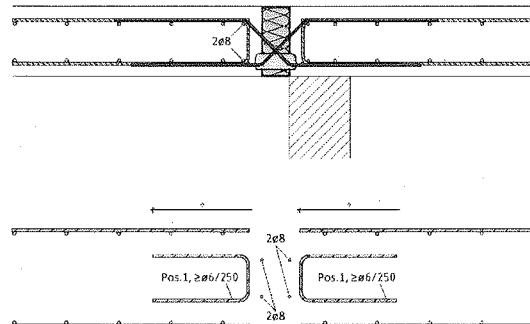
Bewehrungsführung QQ bei direkter Lagerung und deckenseitig geraden Querkraftstäben
